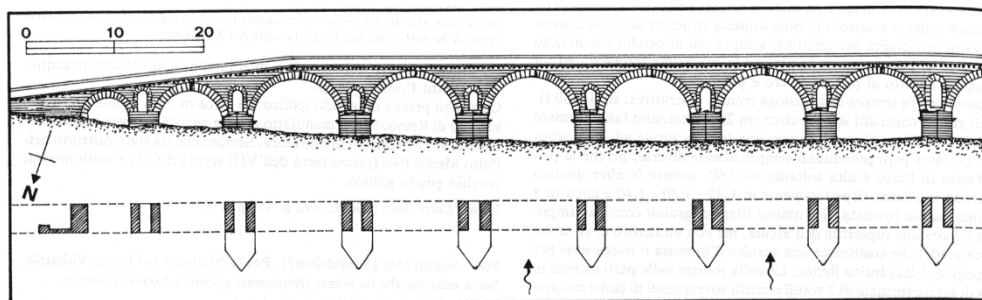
Alçado e planta da Ponte-Viaduto de Sommières.
